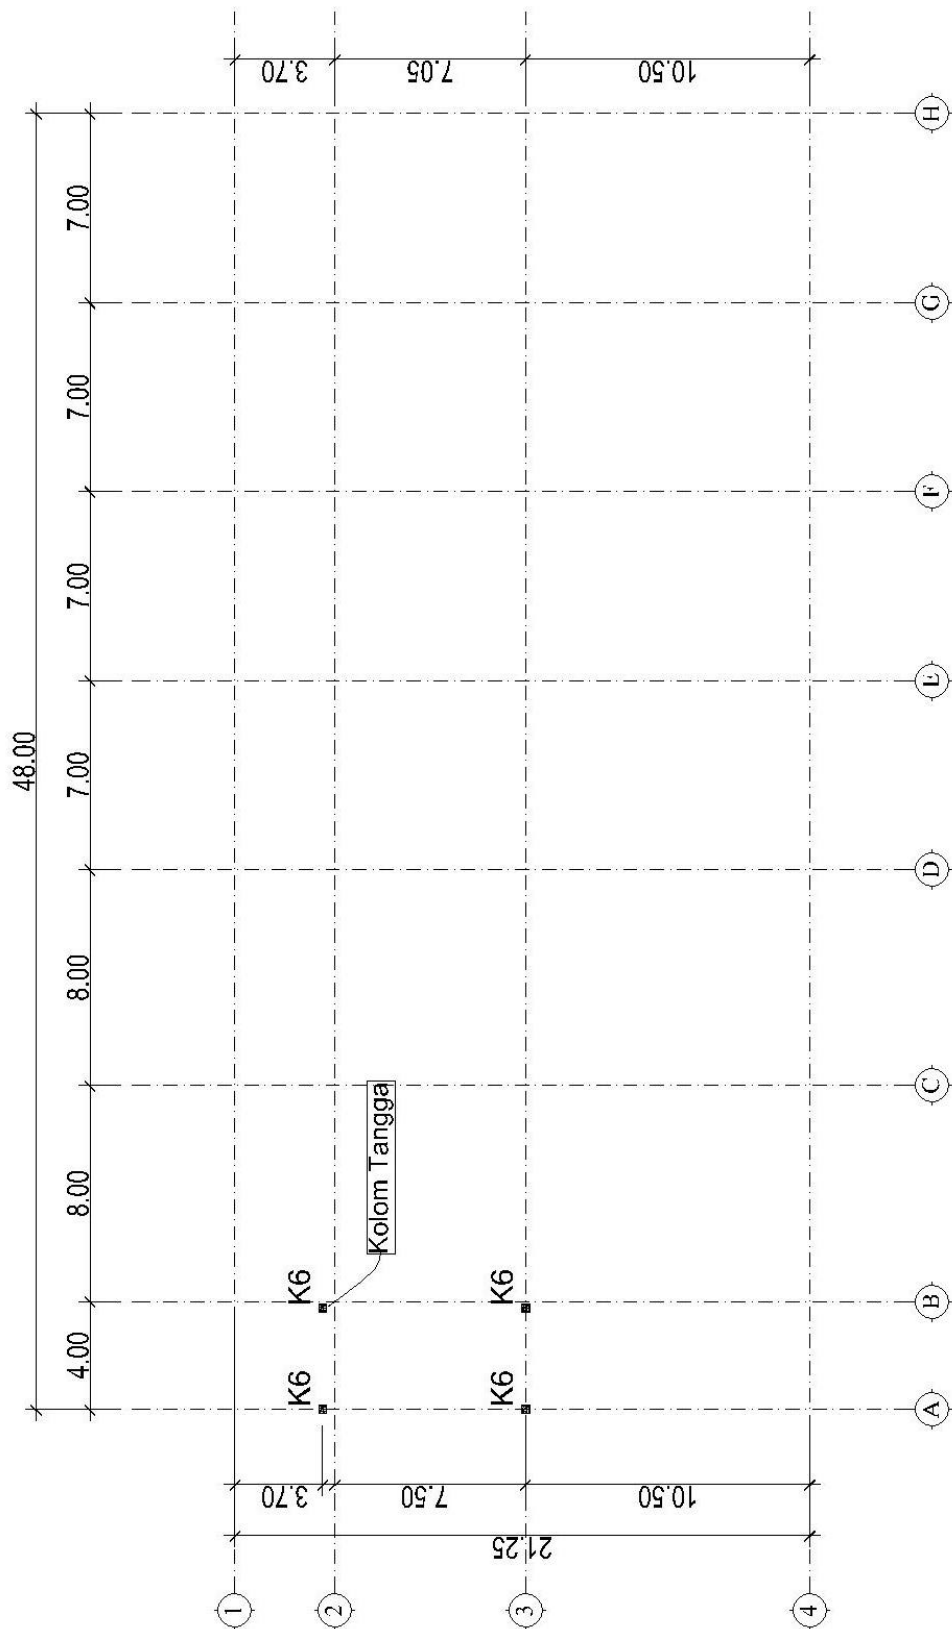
Denah Rencana Kolom Elv. + 4.68
